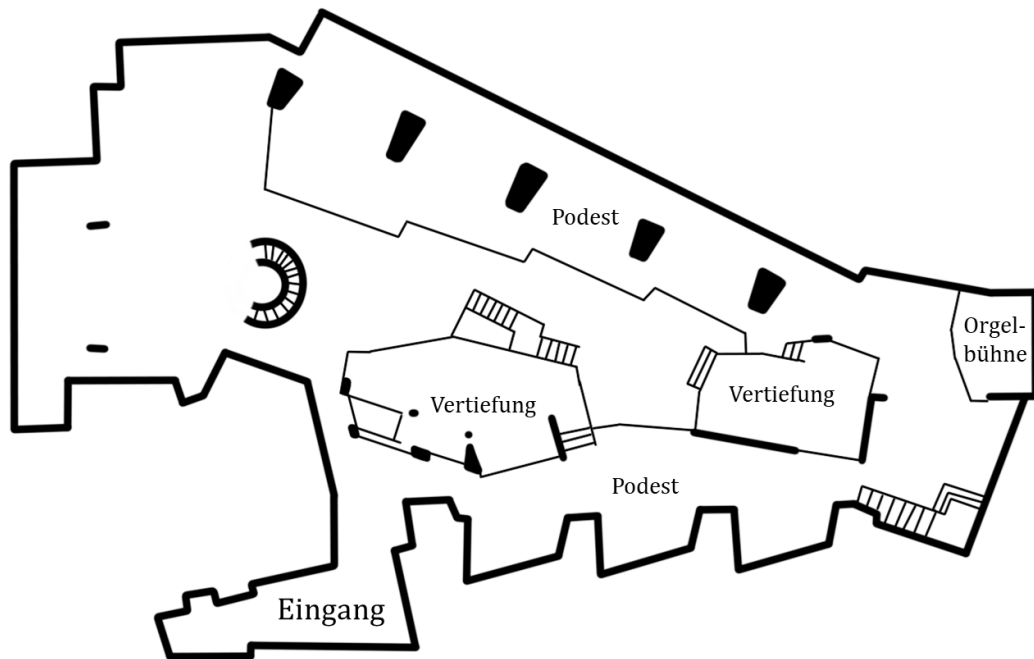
Grundriss des Berliner Musikinstrumenten-Museums, Erdgeschoss
